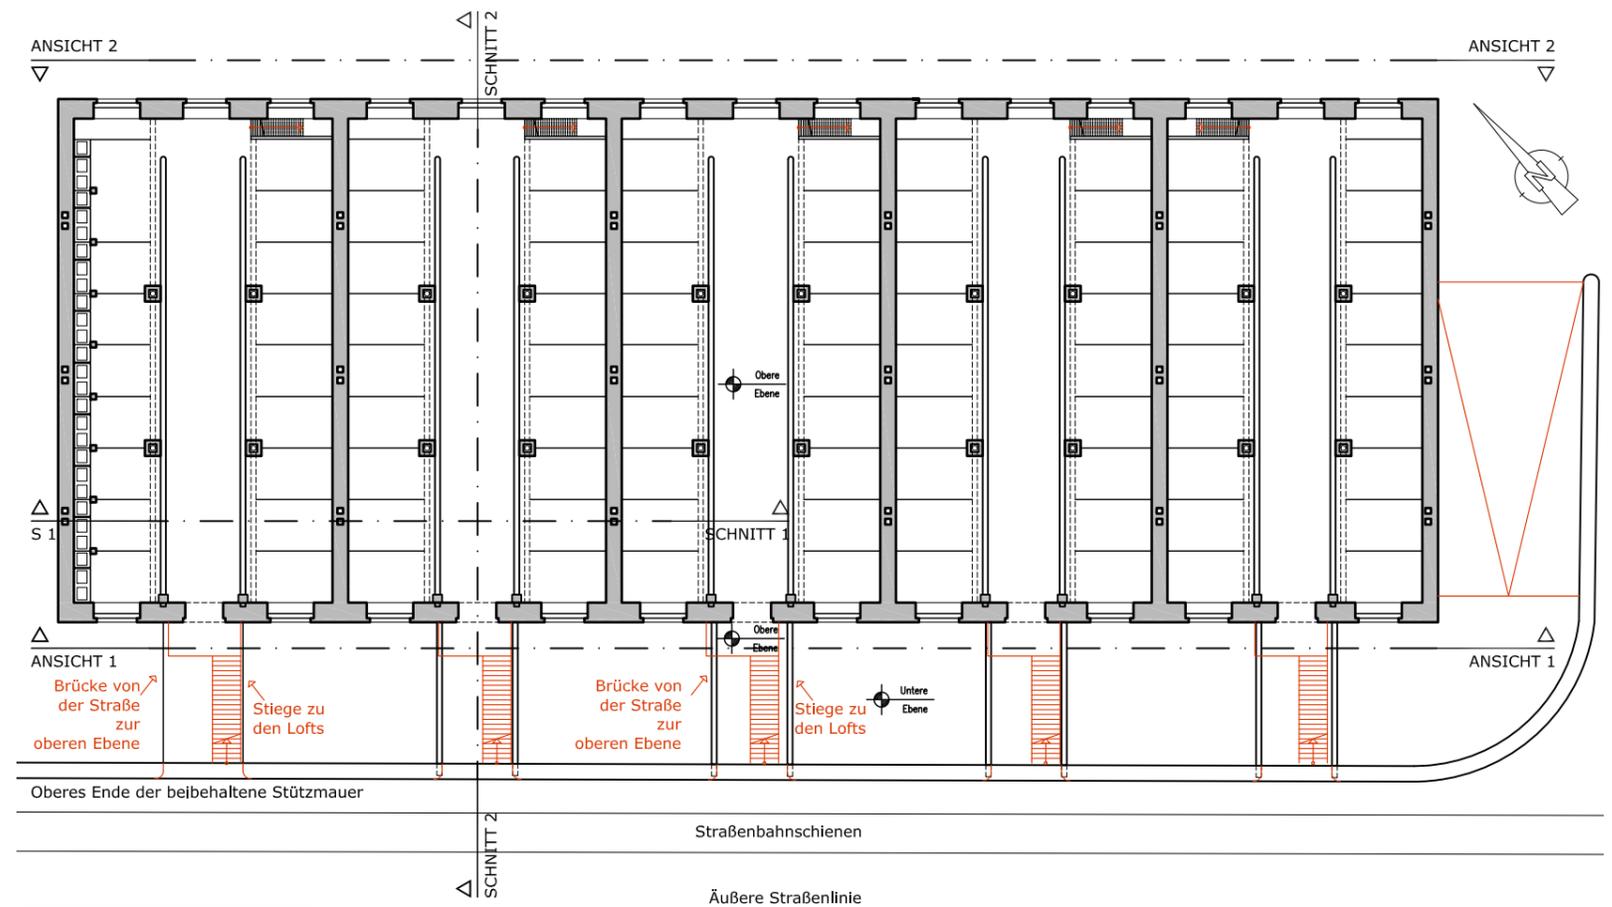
Grundriss der Stallungen - oberen Ebene
